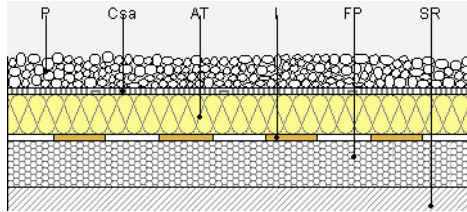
DETALLE CONSTRUCTIVO CUBIERTA PLANA INVERTIDA NO VENTILADA
